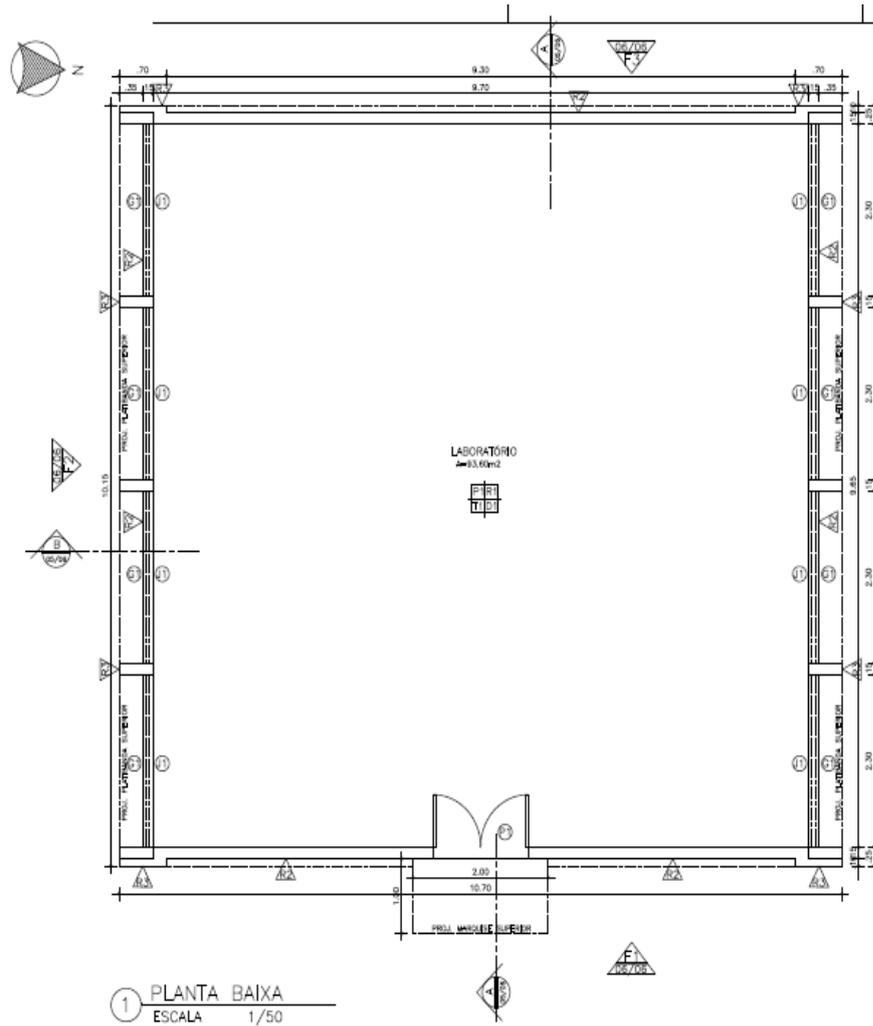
Planta de situação do projeto original do estudo de caso. (Fonte: COP/UFC)
